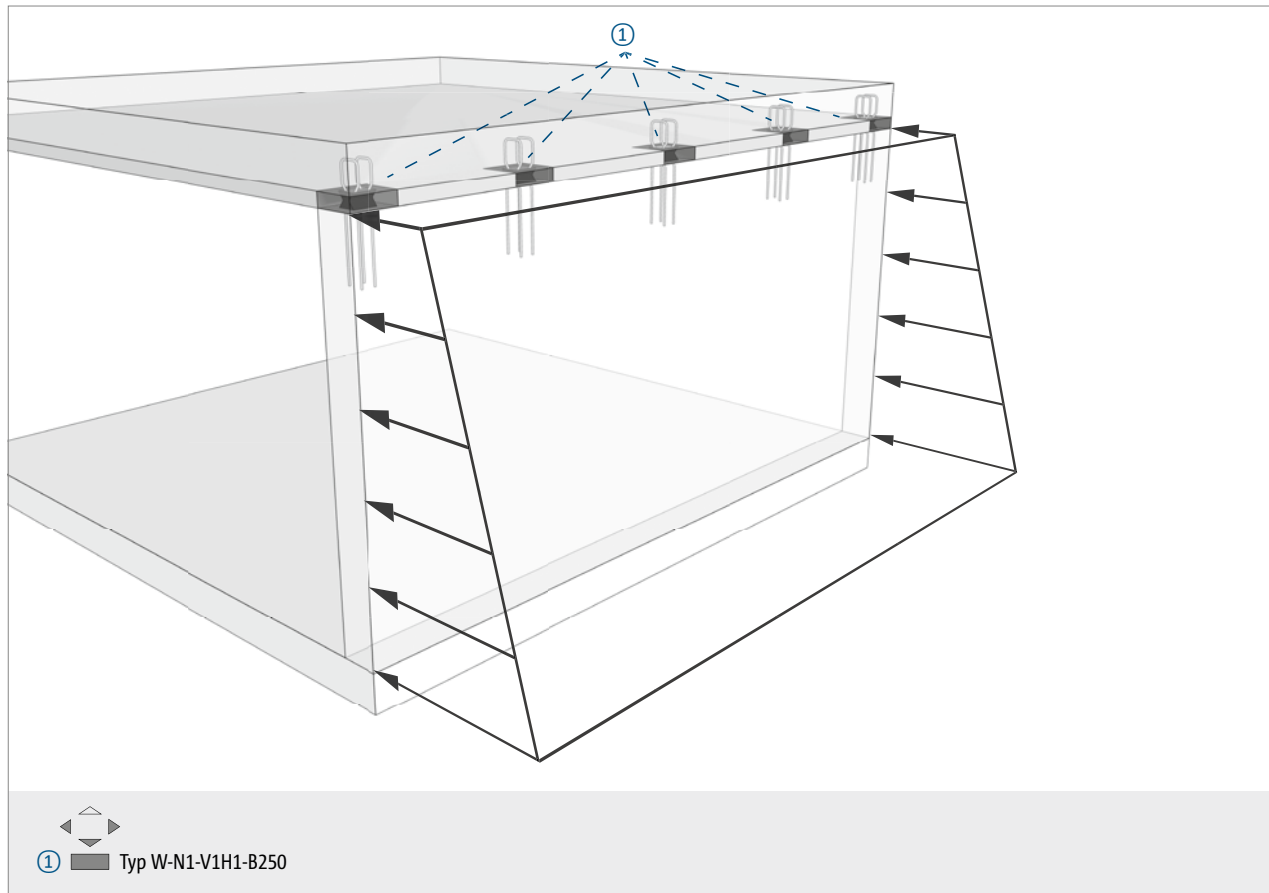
Erddruckbelastete Wand unter Decke getrennt
